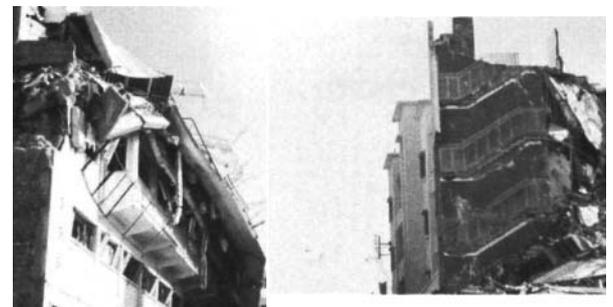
A gauche, l'immeuble 'Sud Building' en béton armé, un bâtiment en maçonnerie à droite
